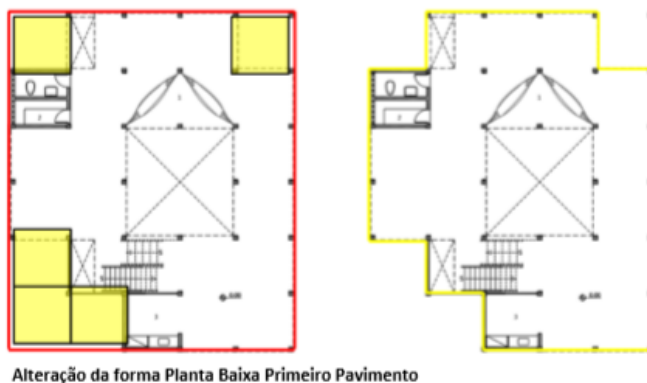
Alteração da forma na planta baixa do 1º pavimento
